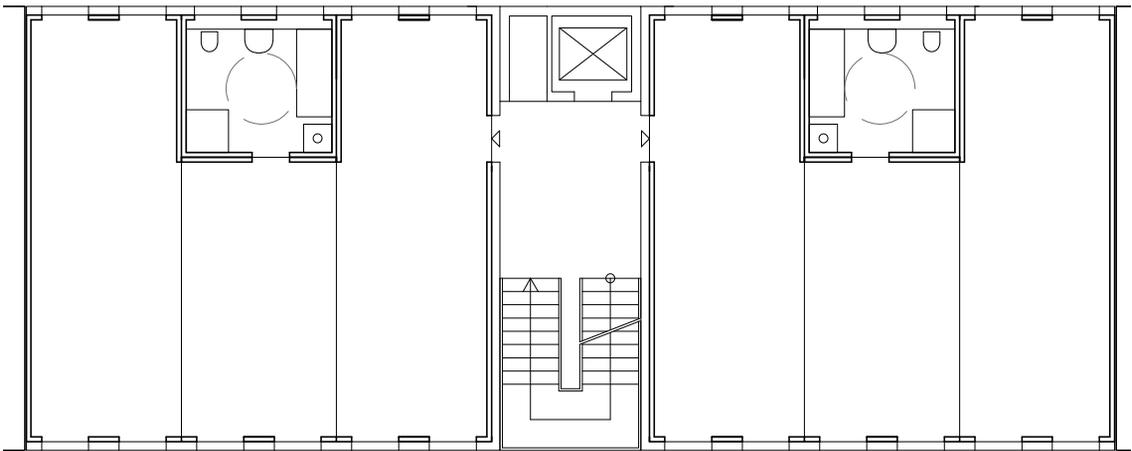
Rohbau Grundriss mit offenen Raummodulen
